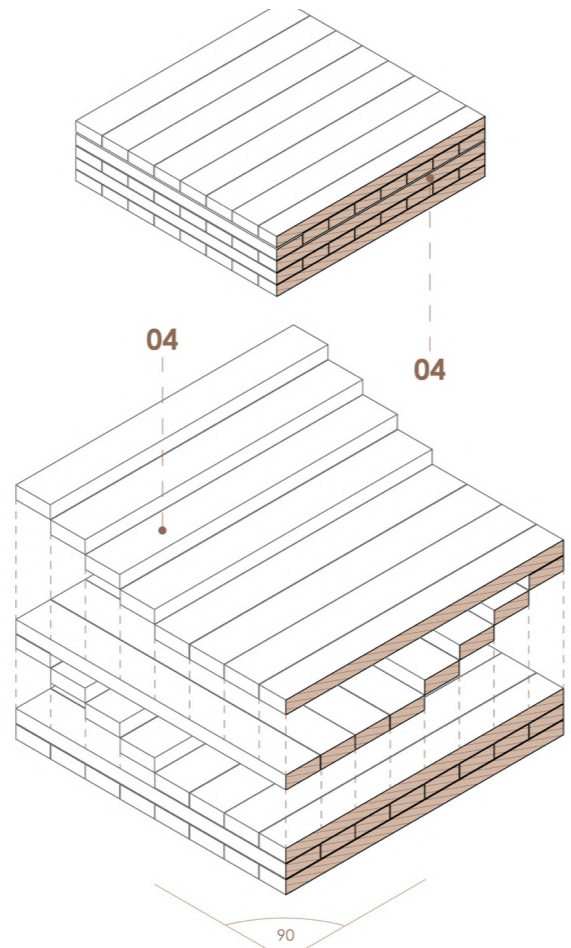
Guía de armado en paneles de CLT para entresijos
